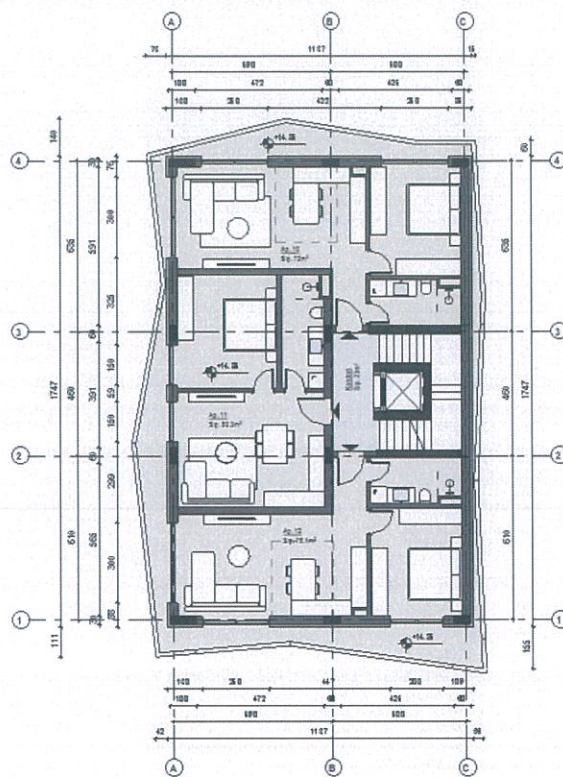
Planimetria e katit +4 me sipërfaqe 240.7 m² (banim)
